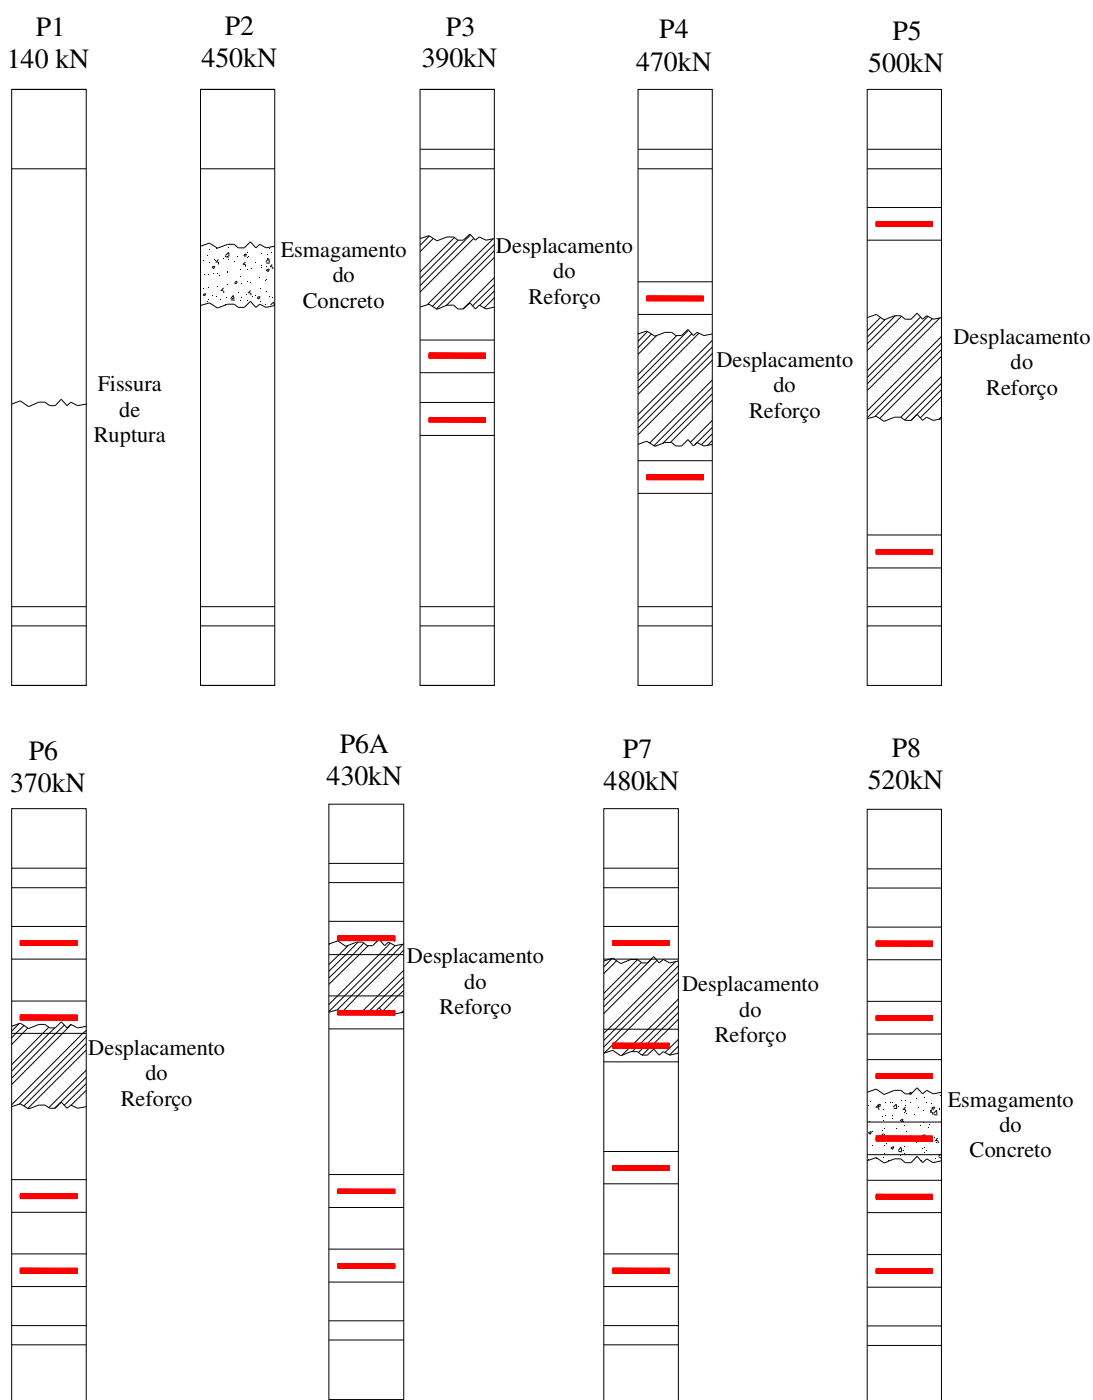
Localização da ruptura nos pilares na face comprimida
